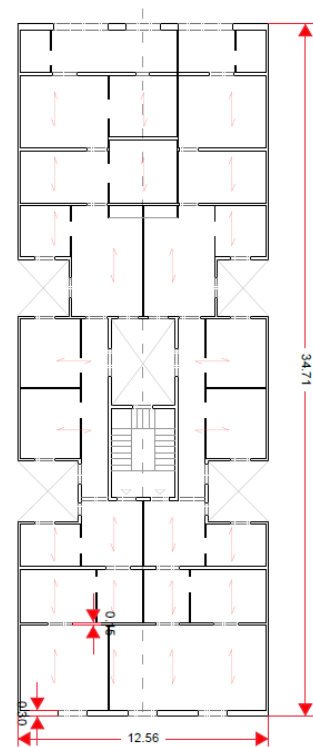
Plano estructural de la distribución en planta del edificio de la calle de Consell de Cent 362 extraído de Cornadó (2015)
